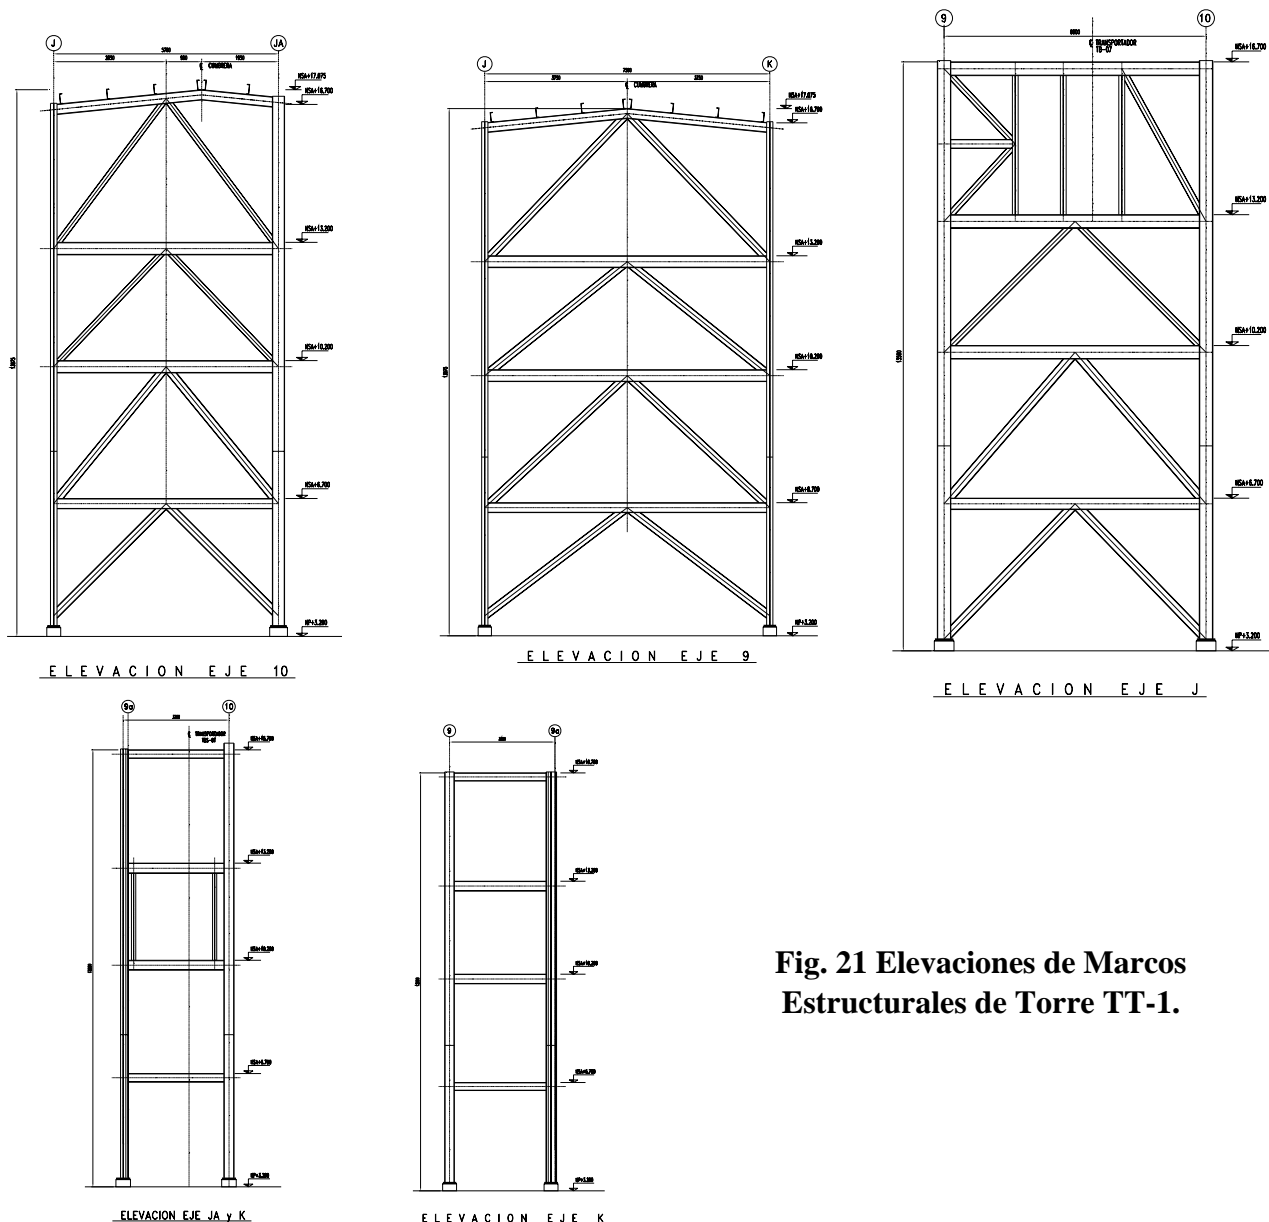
Elevaciones de Marcos Estructurales de Torre TT-1.
